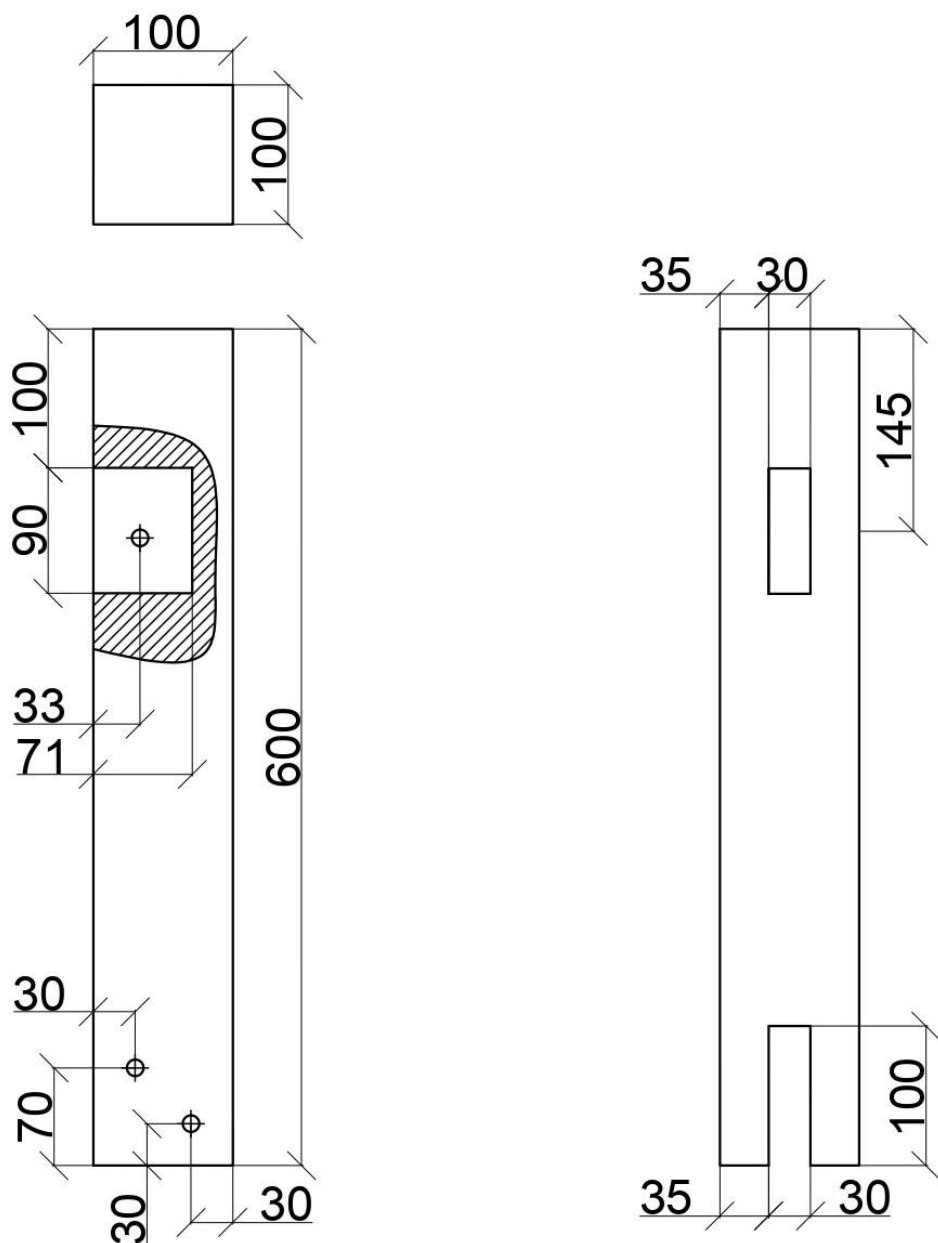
Rysunek konstrukcyjny fragmentu więźby dachowej
